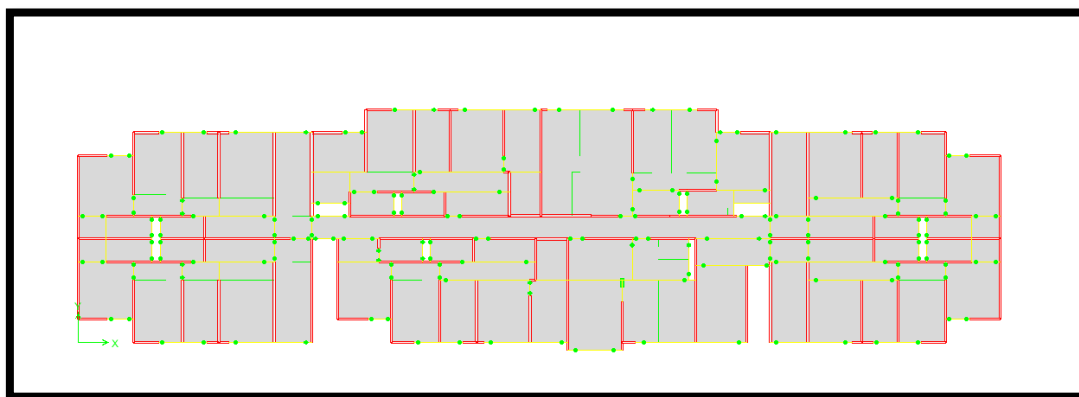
PLANTA DEL MODELO ESTRUCTURAL
